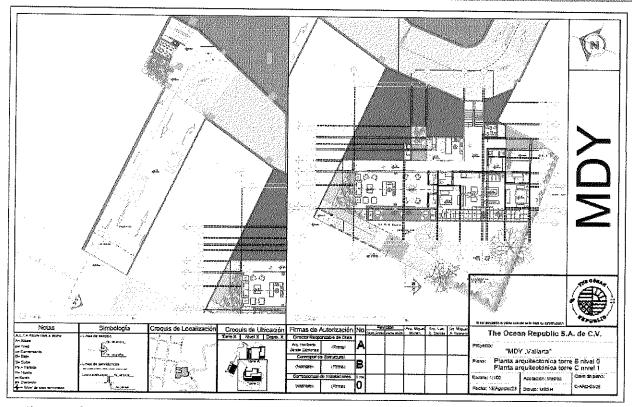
Planta arquitectónica torre B nivel 0, Planta arquitectónica torre C nivel 1
